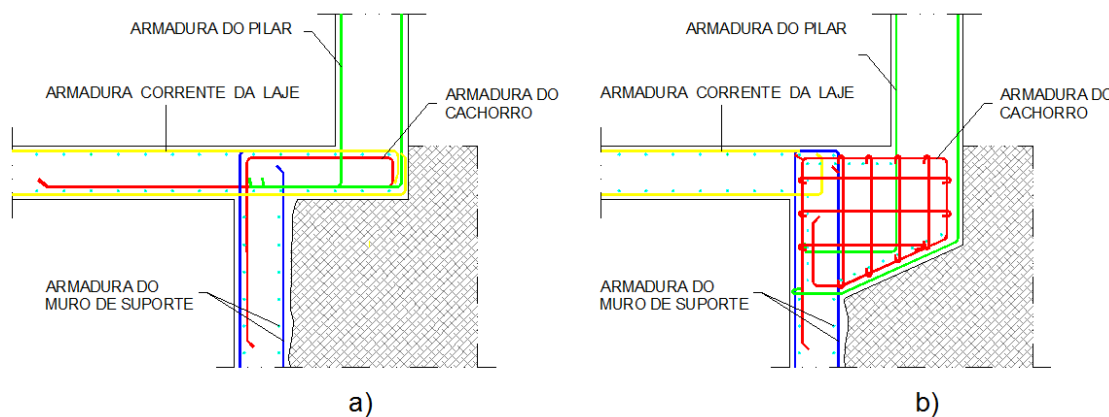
Cachorro para desviar os pilares acima do muro de suporte (adaptado de [42])
